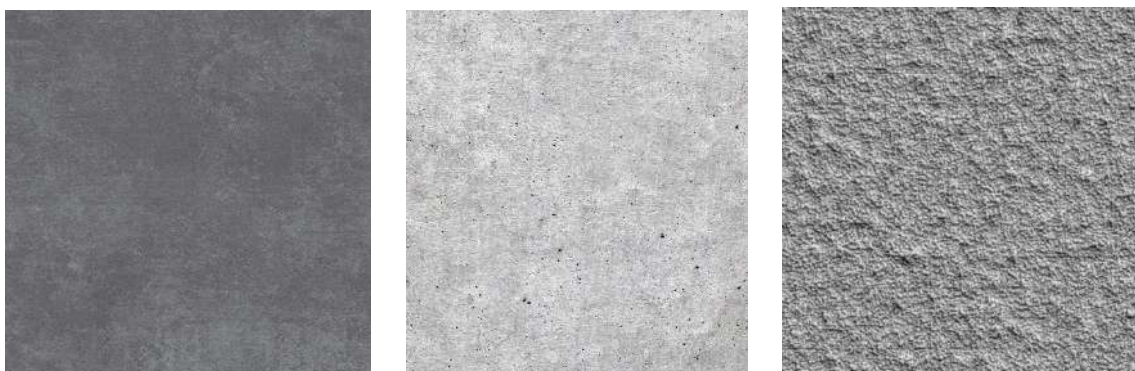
TIPOS DE REVOQUES DE CONCRETO
